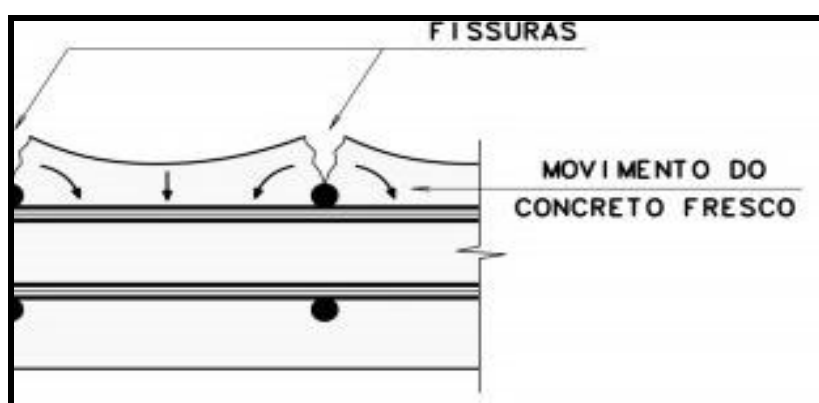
Exemplo de fissura de assentamento plástico ou movimentação de fôrmas. Fonte: Filho e Carmona (2013).
